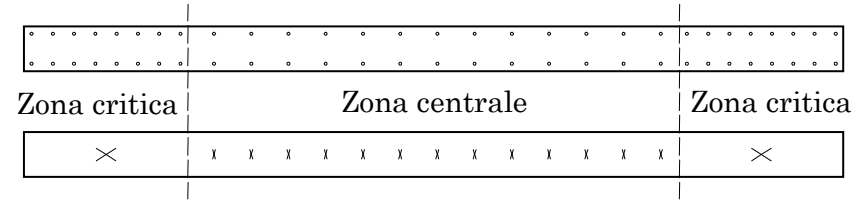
Sezione trasversale ipotetica della parete e schematizzazione della posizione dell’armatura
